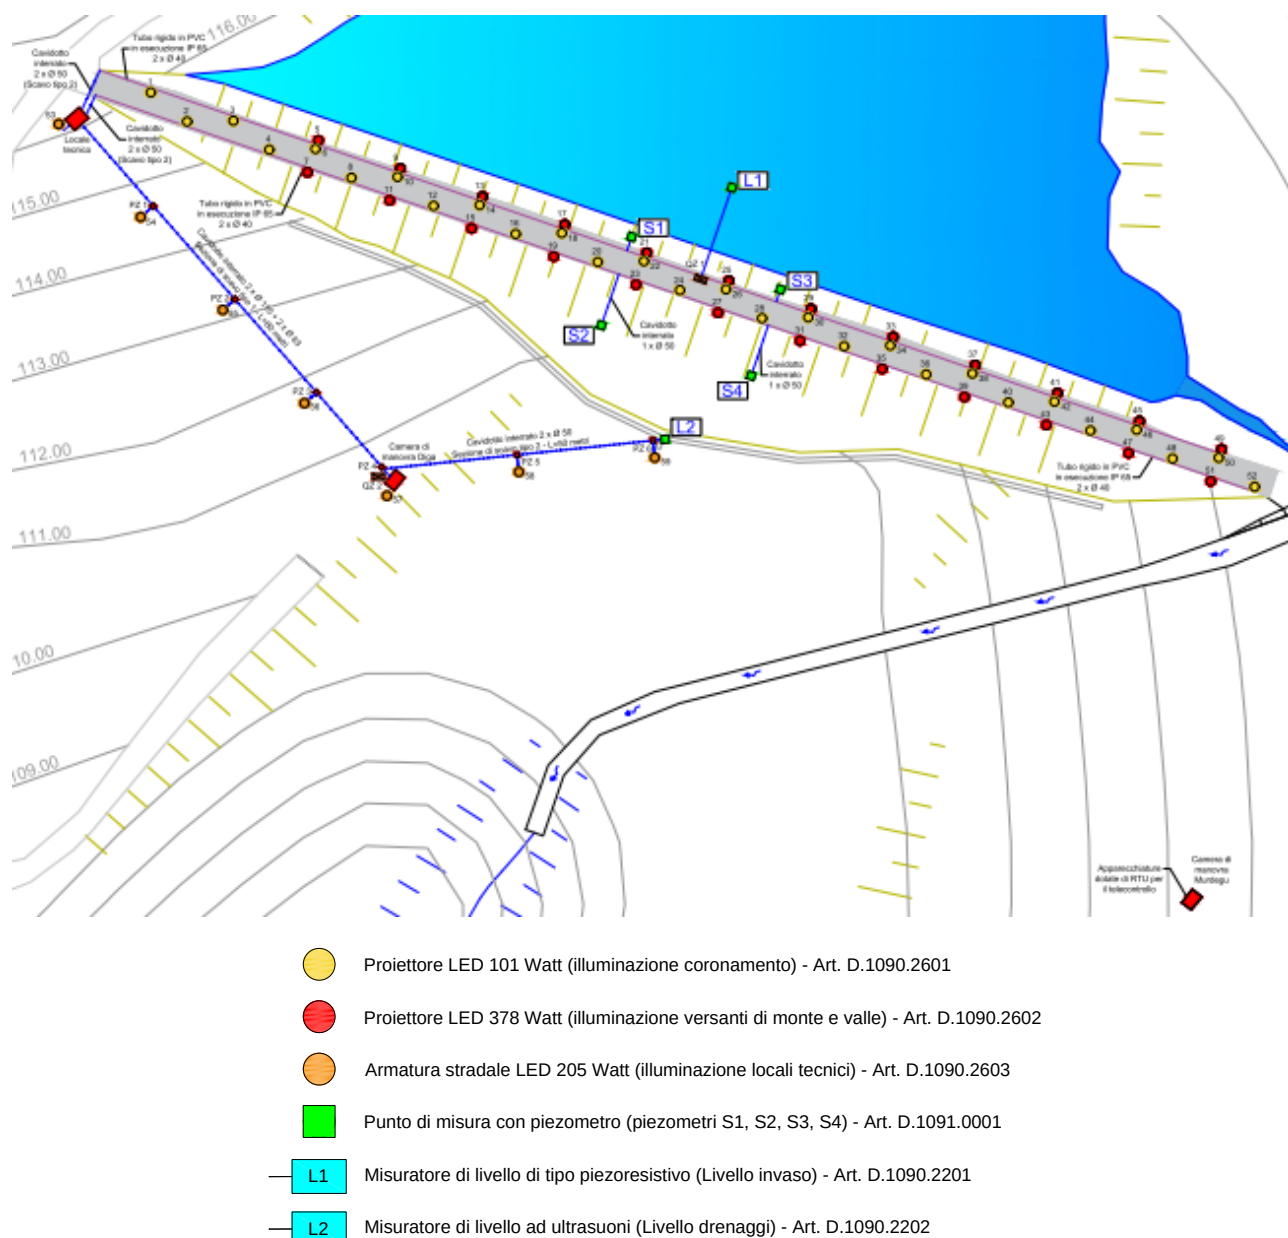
Planimetria della diga con indicazione dei corpi illuminanti, delle linee elettriche e del nuovo locale tecnico
